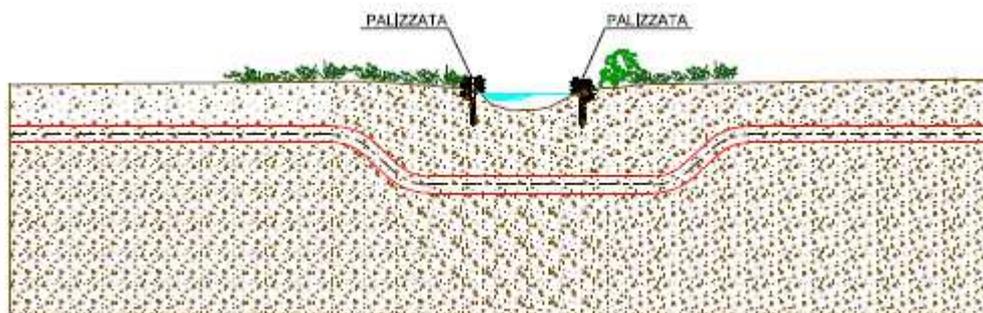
Attraversamento fosso San Rocco - Sezione schematica di progetto
